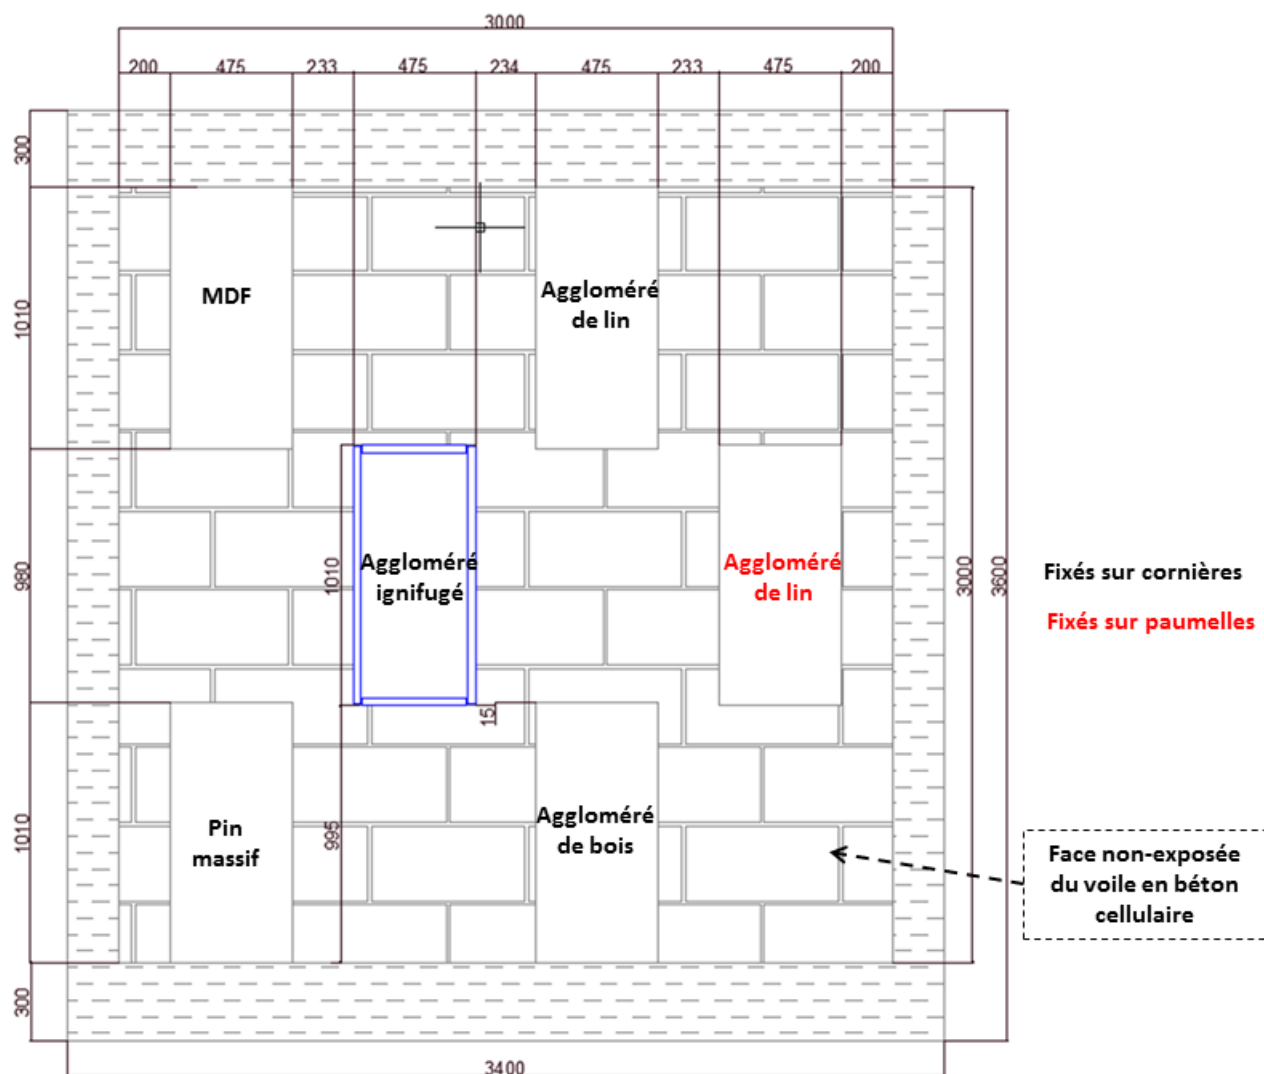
Plan de la face non-exposée du four de résistance au feu pour l'essai à grande échelle sur six panneaux de bois.
